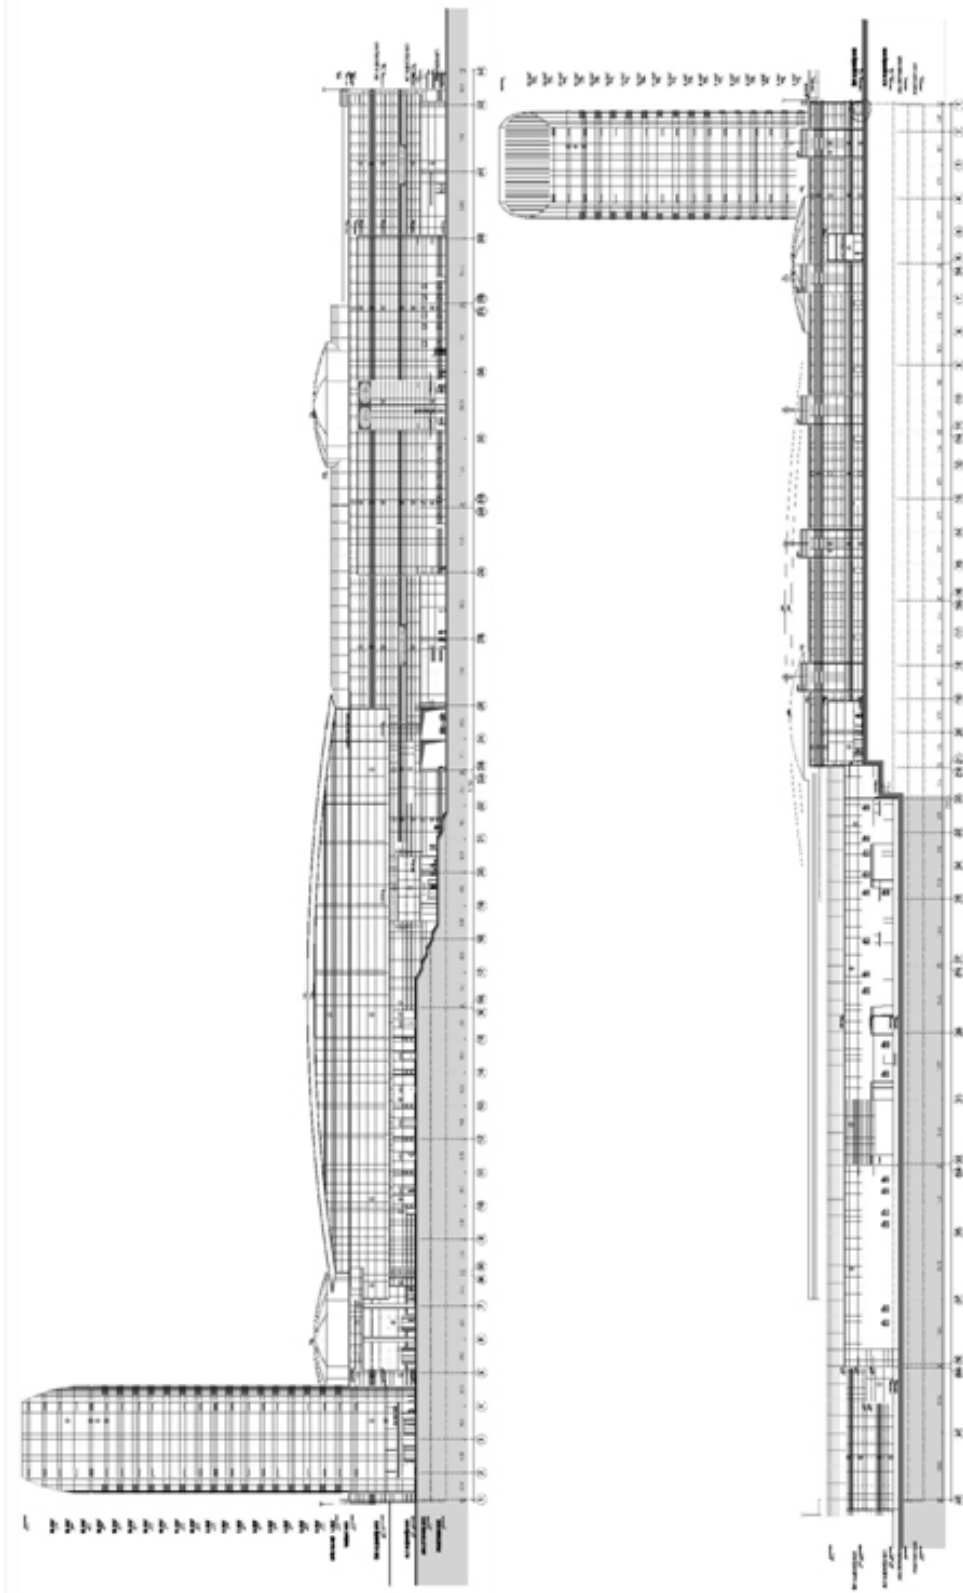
Antares Alışveriş Merkezi vaziyet planı
